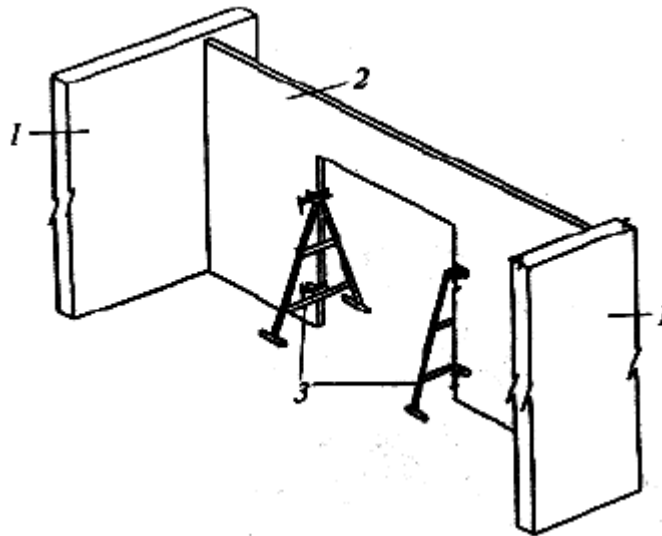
Схема временного крепления железобетонной перегородки:
